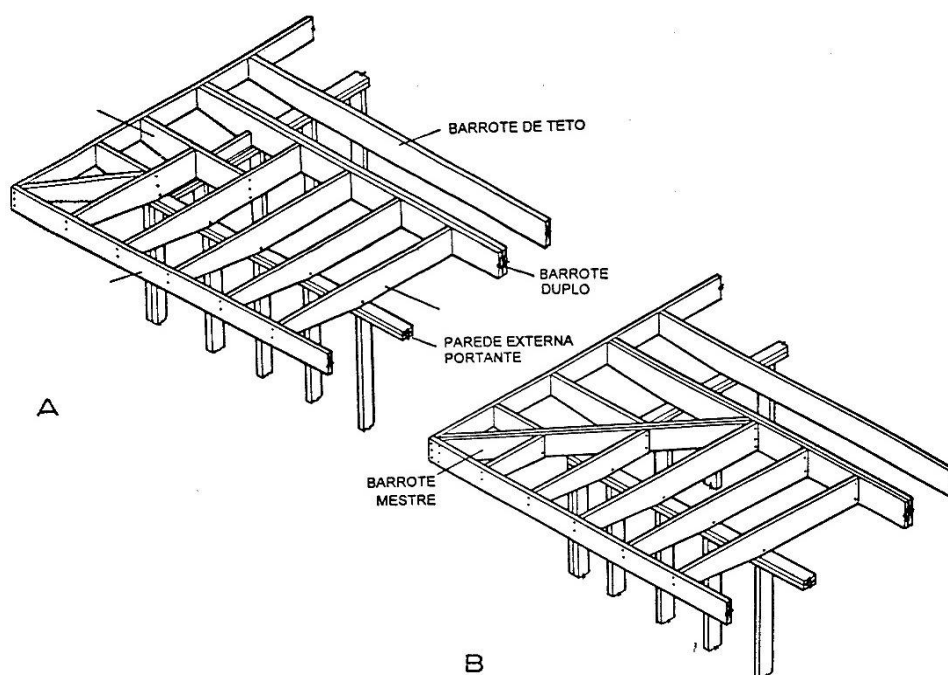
Detalhe construtivo de telhados planos para o sistema plataforma. A – Beiral com menos de 90 cm. B – Beiral com mais de 90 cm
